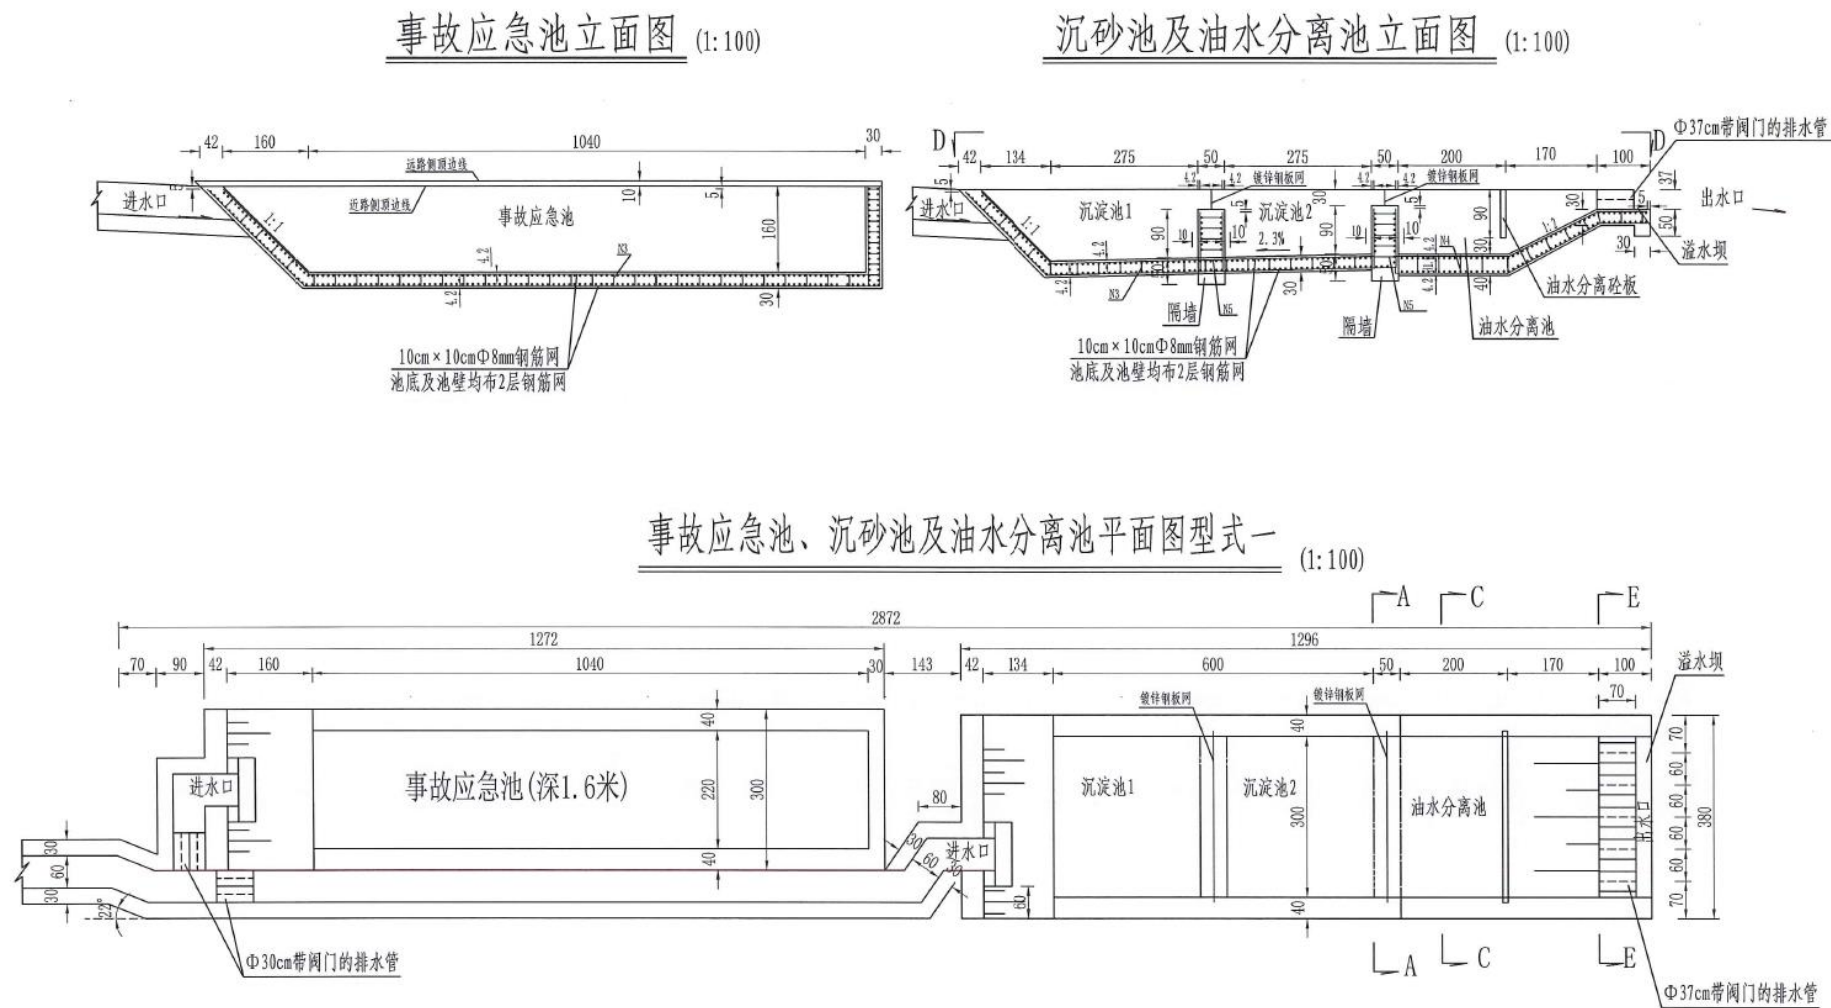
沉淀池与事故应急池立面及平面布置示意图
